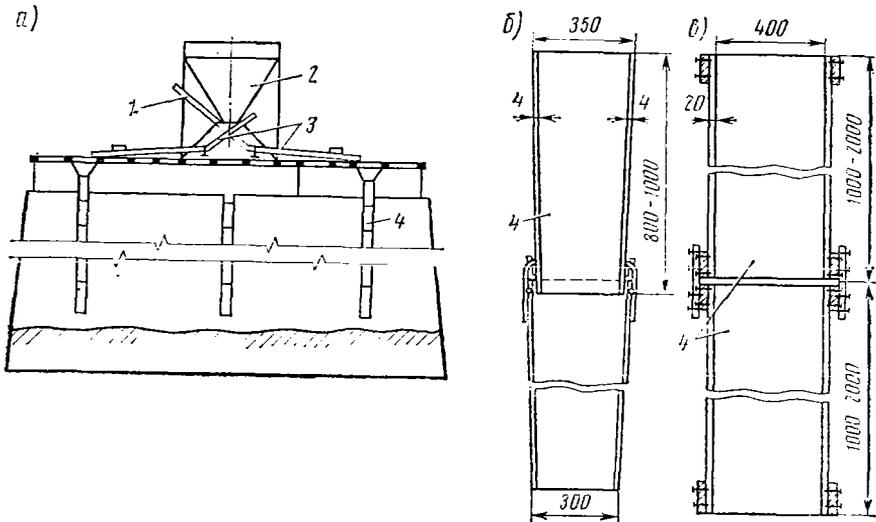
Схема подачи бетонной смеси из бункера по виброточкам и звеньевым трубам:
